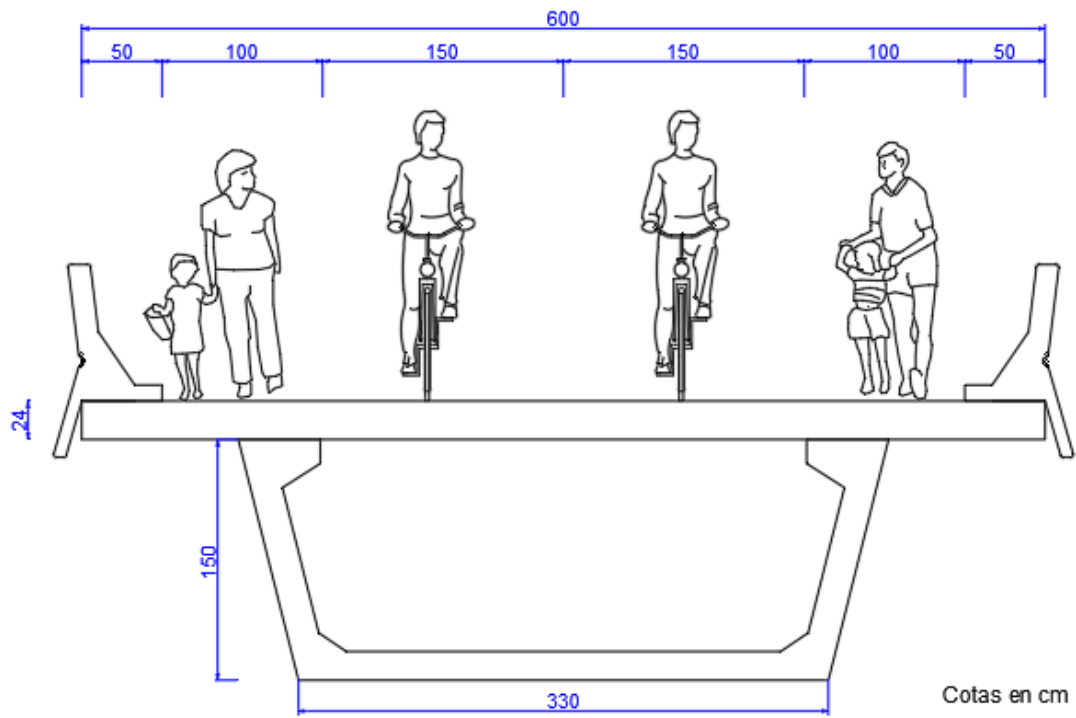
Esquema sección transversal de viga cajón + losa de compresión
